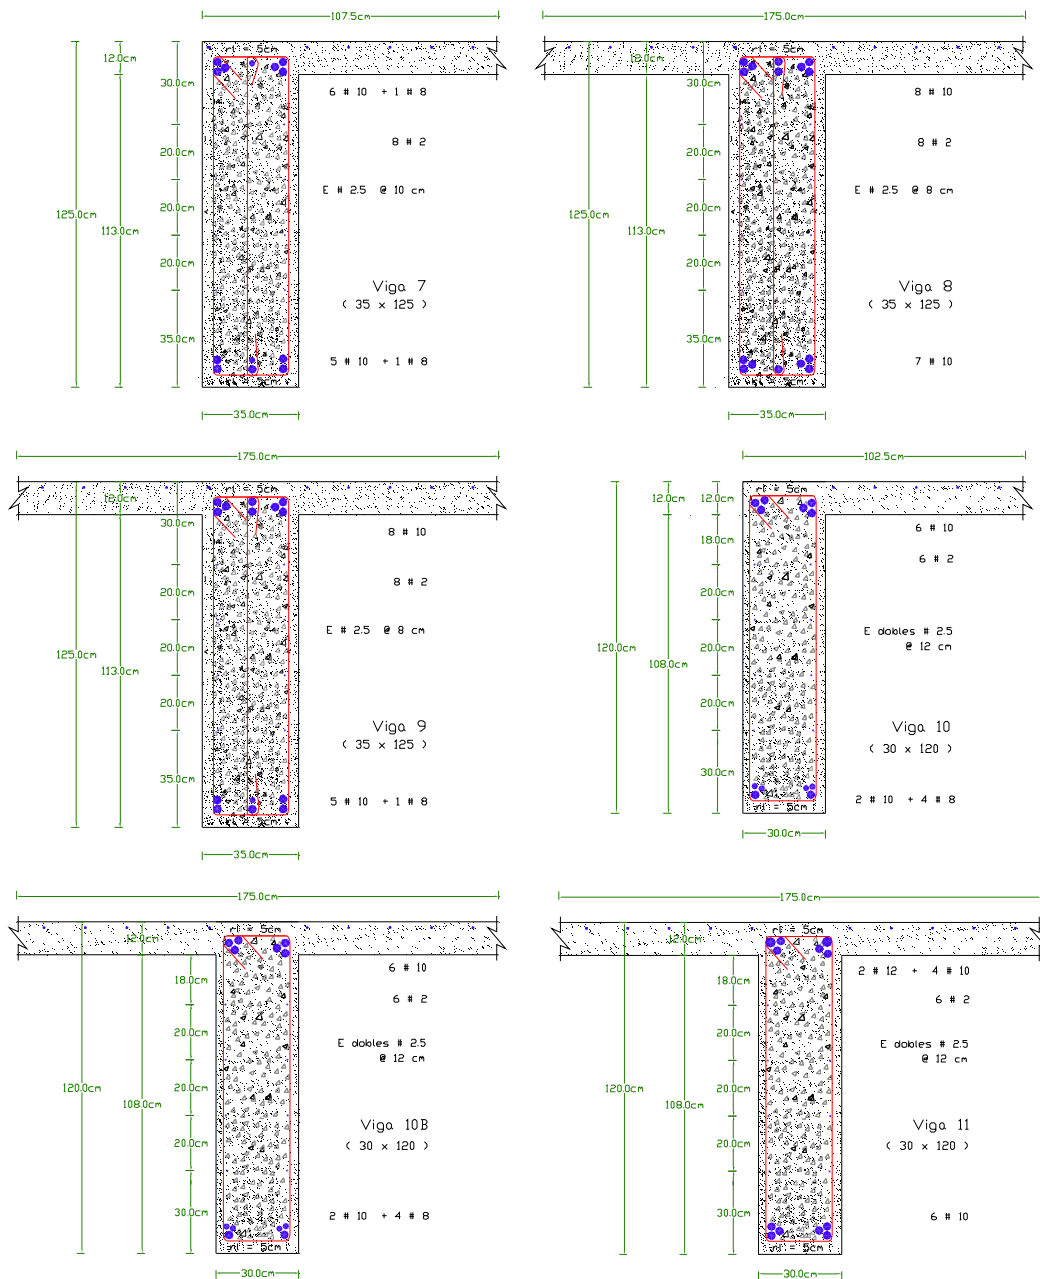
Dimensiones y armado de vigas, edificio III_15 (continuación)
